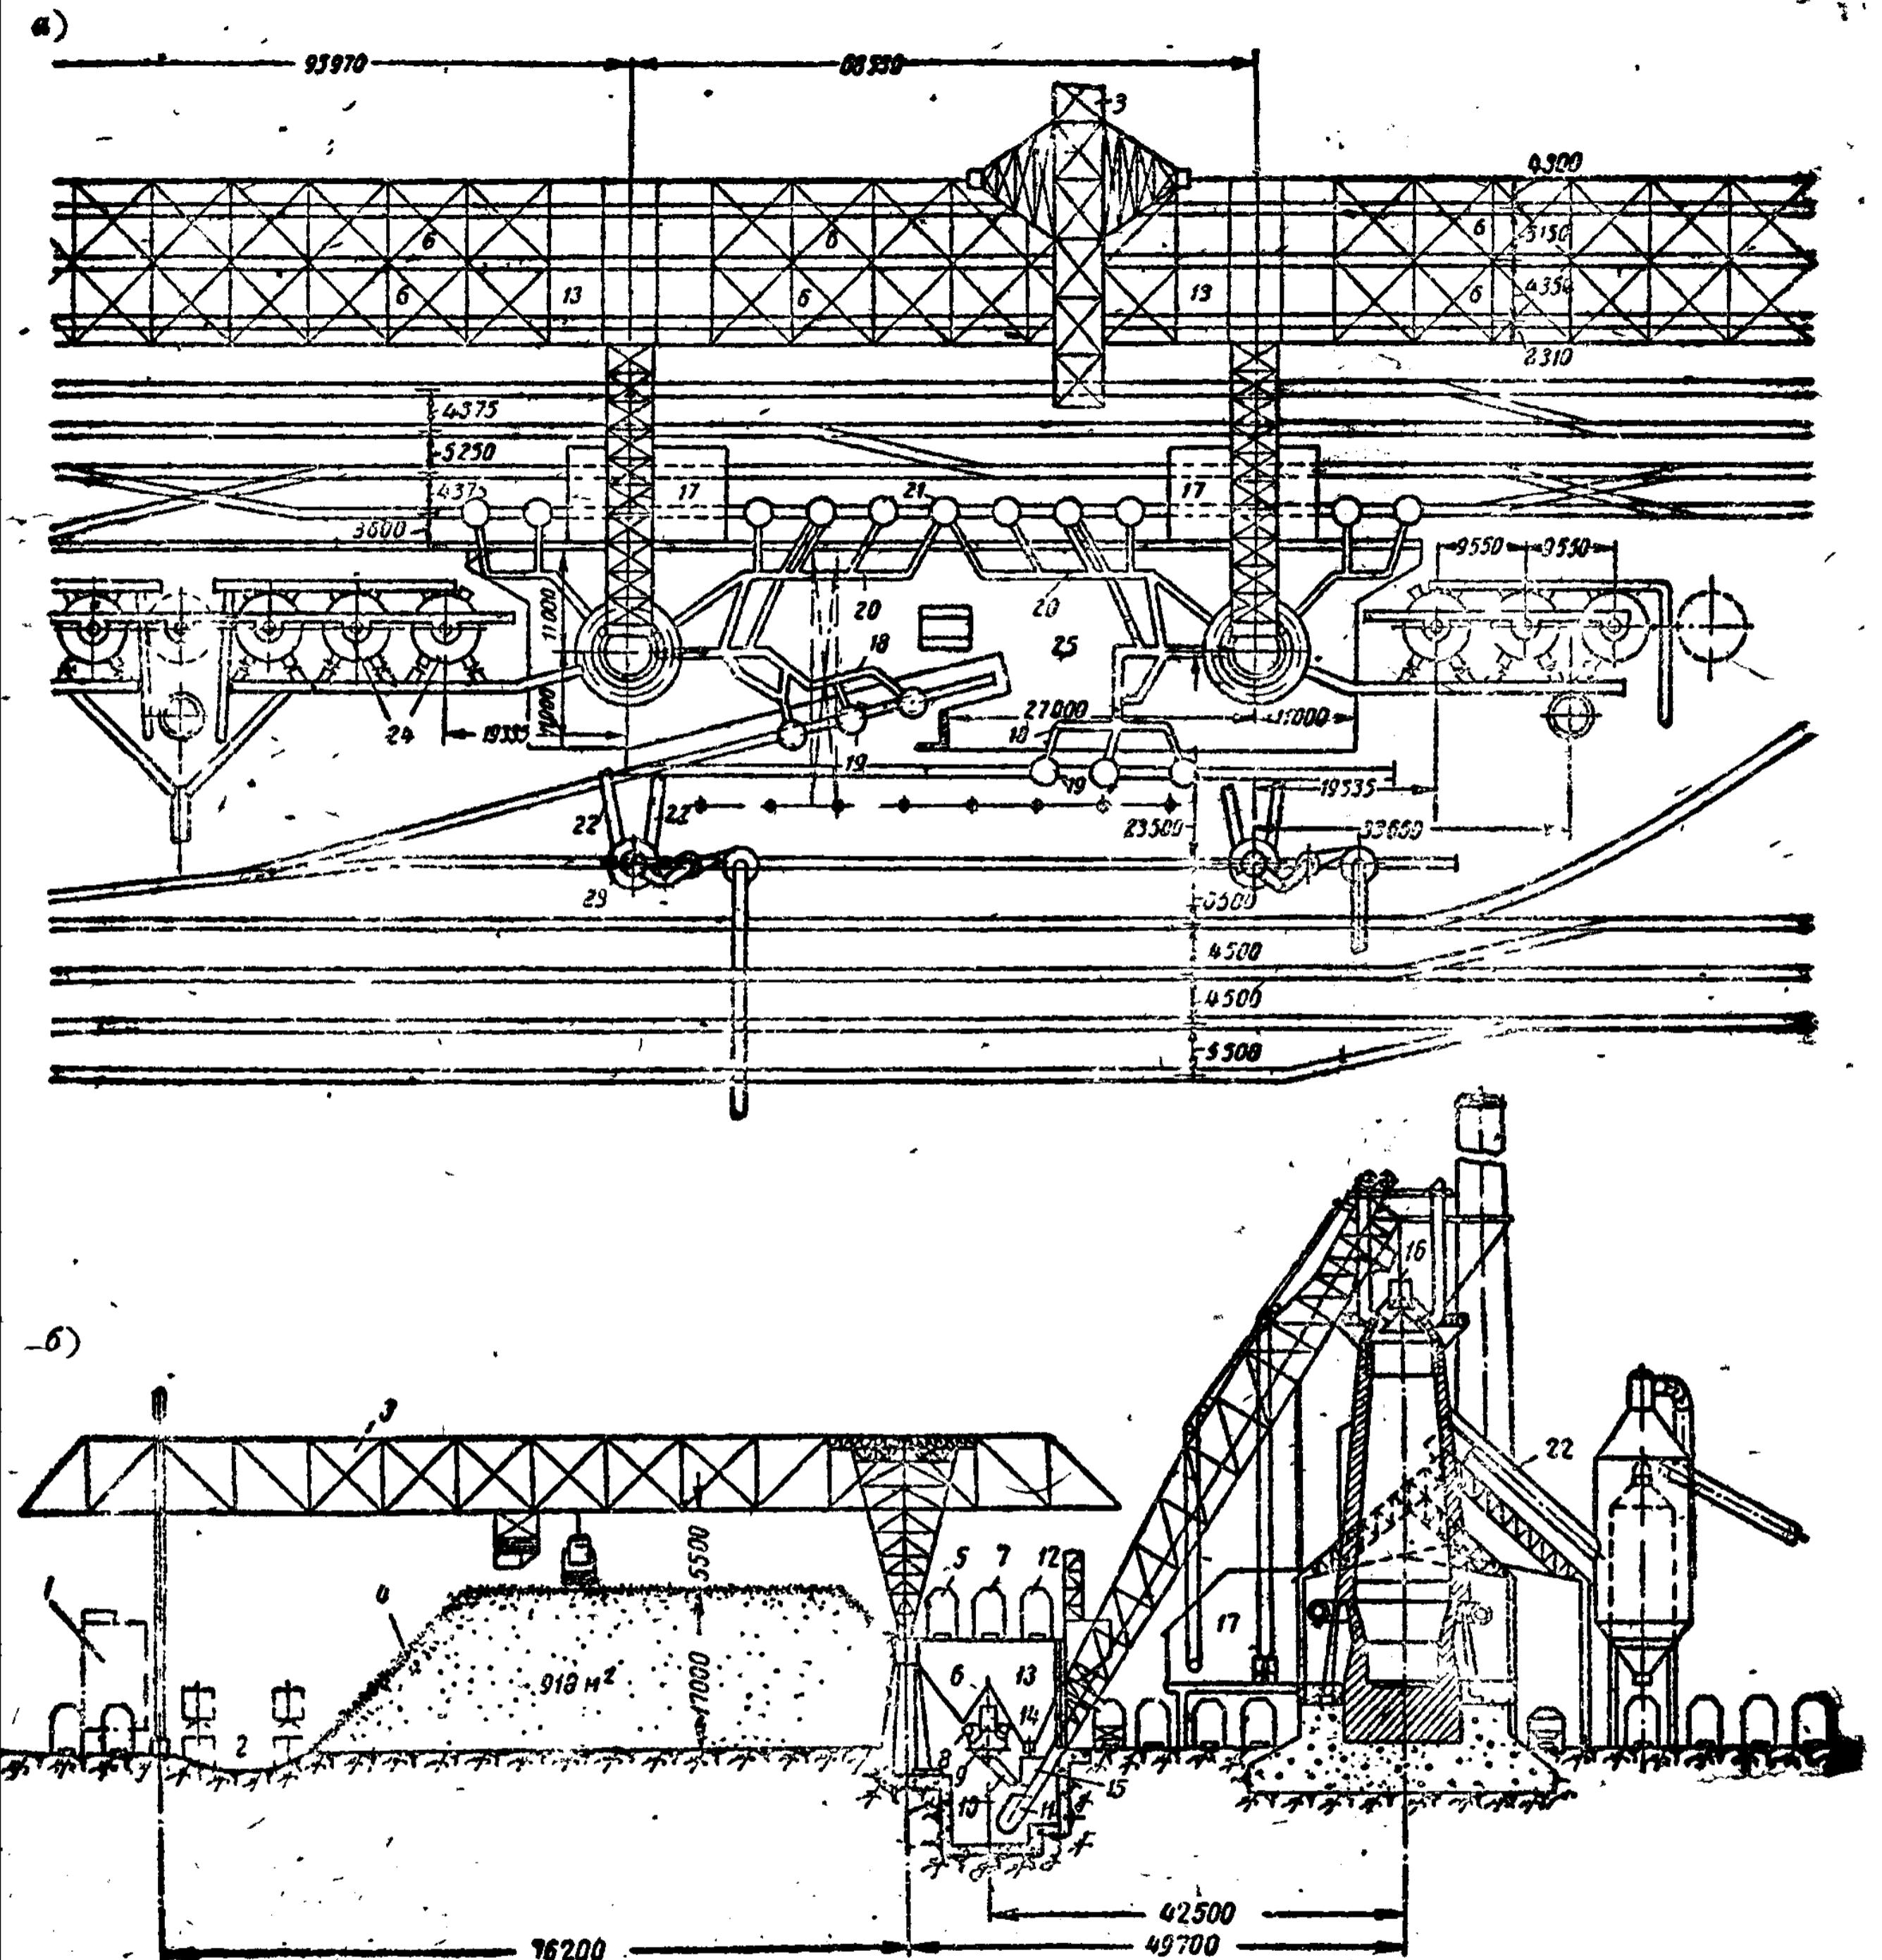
并列式车间配置(a—平面布置图; b—剖面图; )
